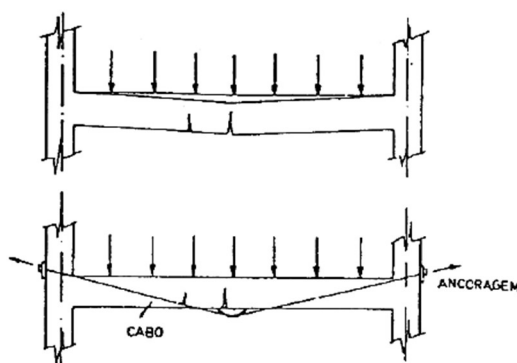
Reforço e eliminação de deformação de uma viga [39]
